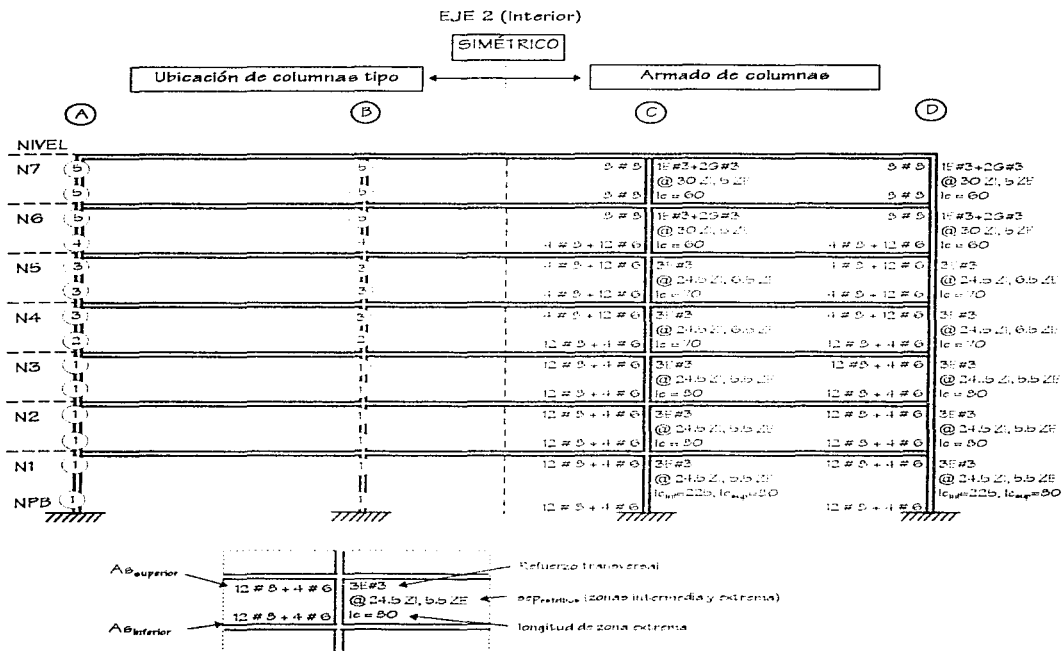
Ubicación de los tipos de armados de las columnas del eje 2 de la estructura diseñada en la zona III
